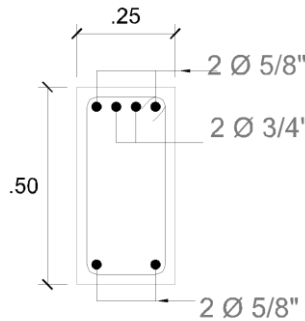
32 b SECCIÓN DE VIGA
